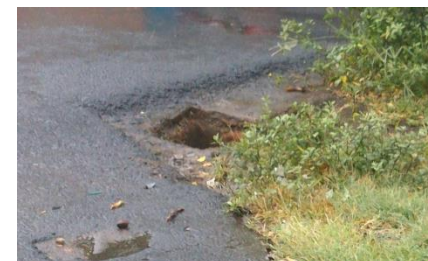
Estado Físico de Drenajes Pluviales
